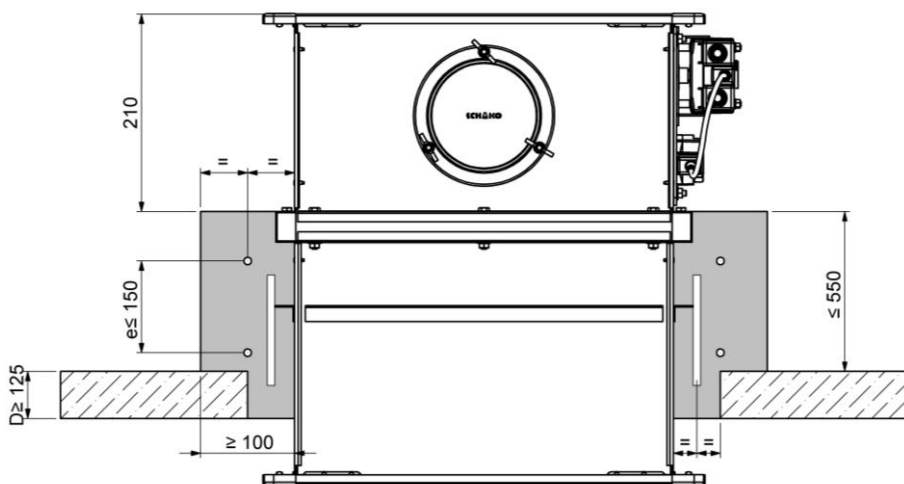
montaggio in soffitti massicci con zoccolo in calcestruzzo, sezione
